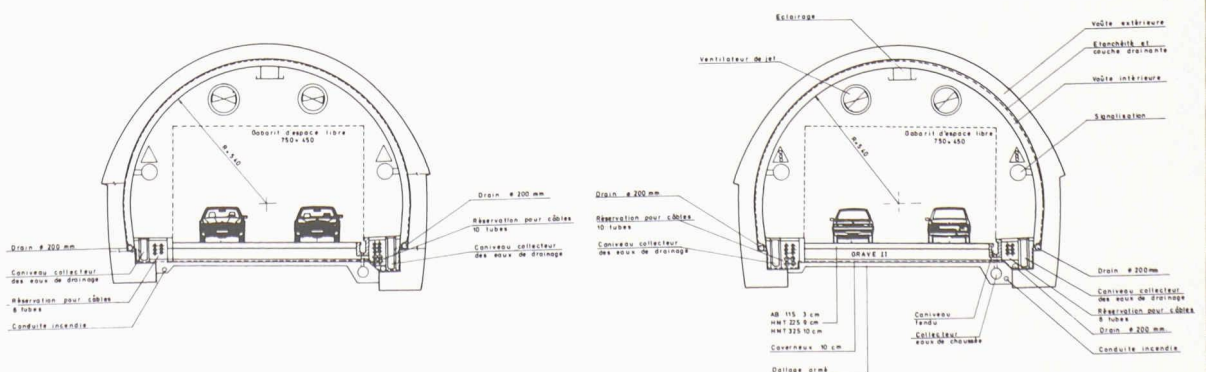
Tunnel sous le coteau de Cologny: coupe type
